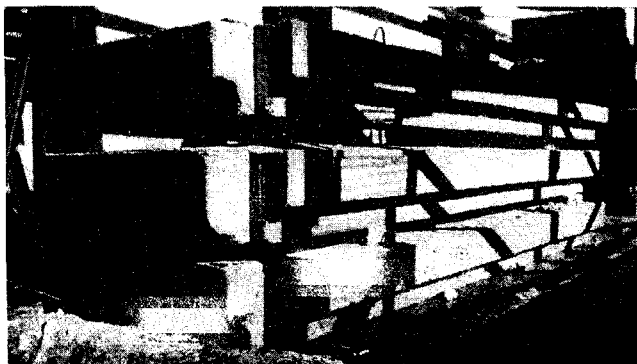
Предлагаемые диски перекрытия (отдельные элементы)
